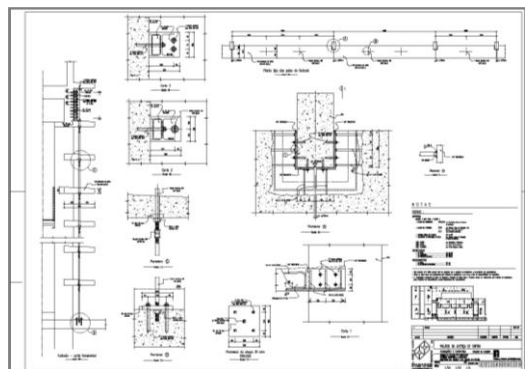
Pormenores de suspensão das lâminas de fachada e respectivas ligações aos pilares de b.a.
